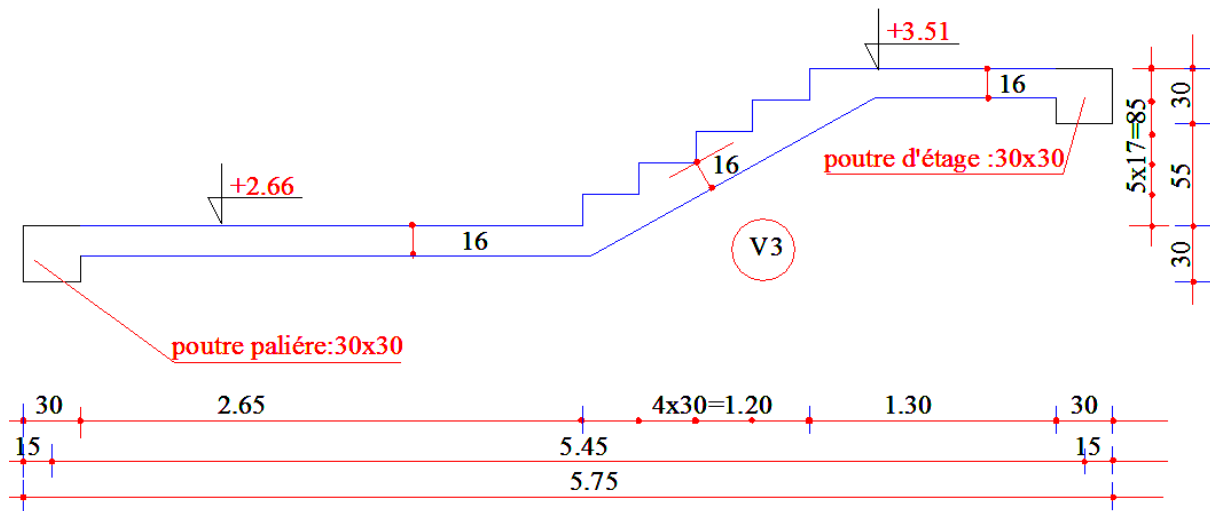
coupe d'escalier N°1 -volée-3- Niveau RDC et 16 ETAGE
